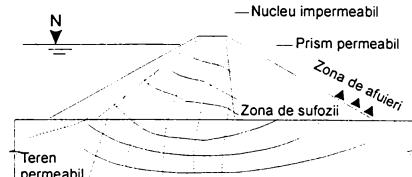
Baraje din pamant. Zona de sufozii si afuieri.
